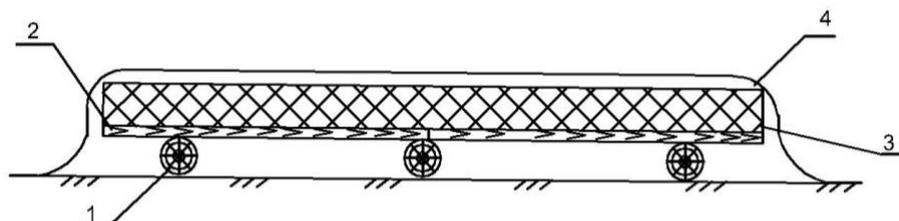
Схема утепления грунта воздушной прослойкой:
